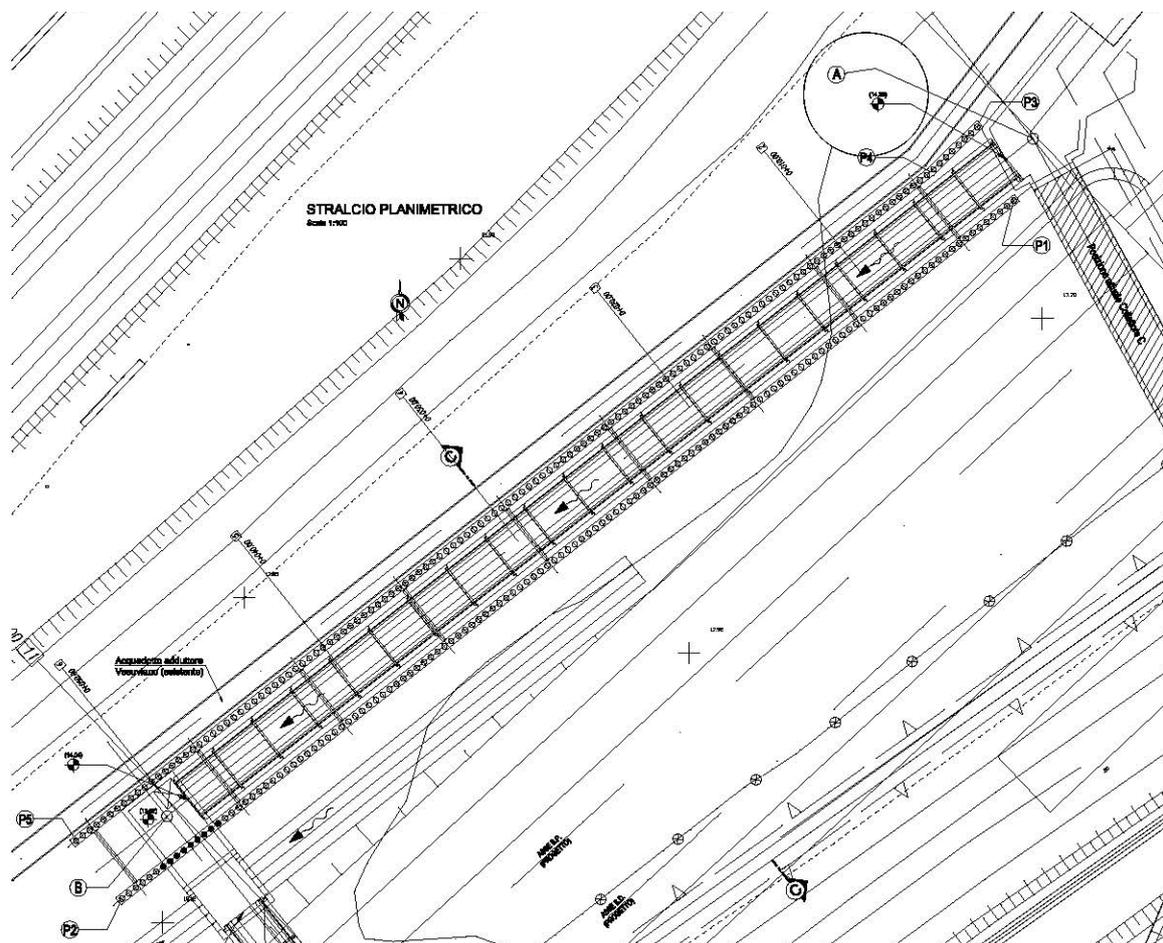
Opera IN08 – Tratto A-B - Vista planimetrica
